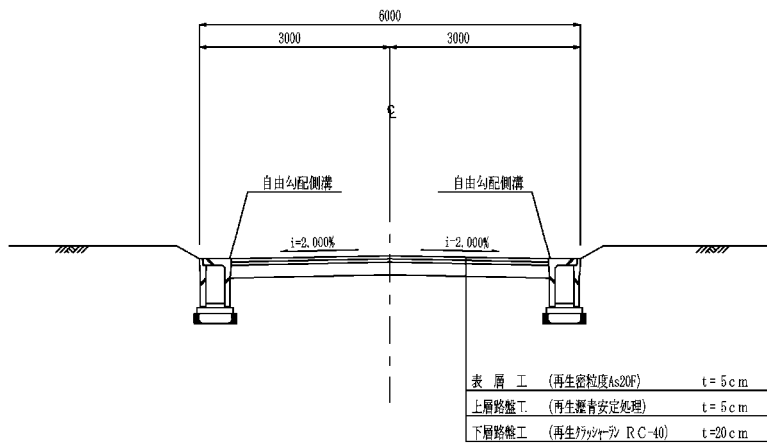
(6) 道路標準断面図(区画道路:6m)
